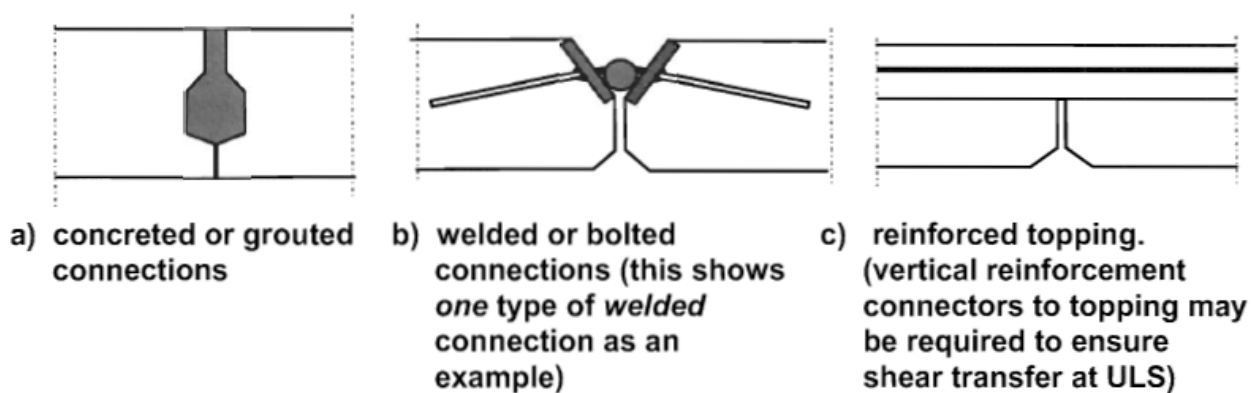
Conexiones a cortante. Adaptado de: Eurocode 2: Design of Concrete Structures (2004)
